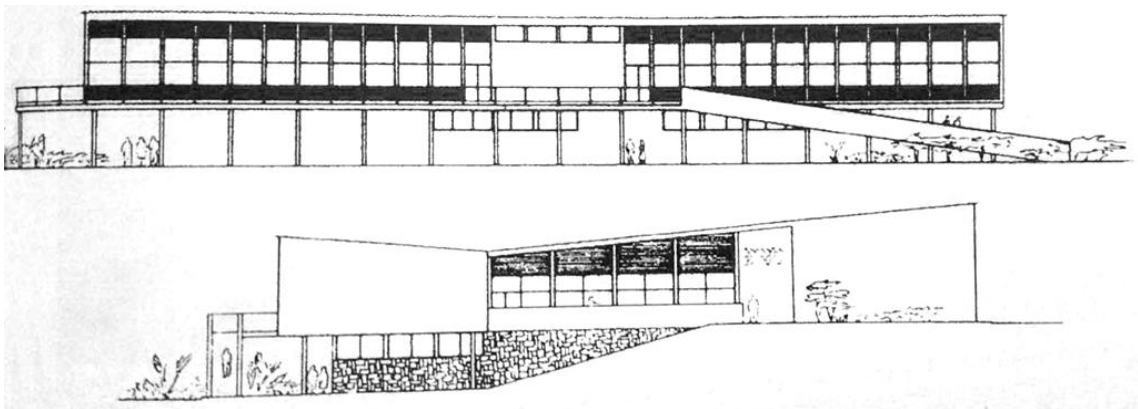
Fachadas Pavilhão Carlos Augusto da Silva (Fonte: DAD/Fiocruz)
